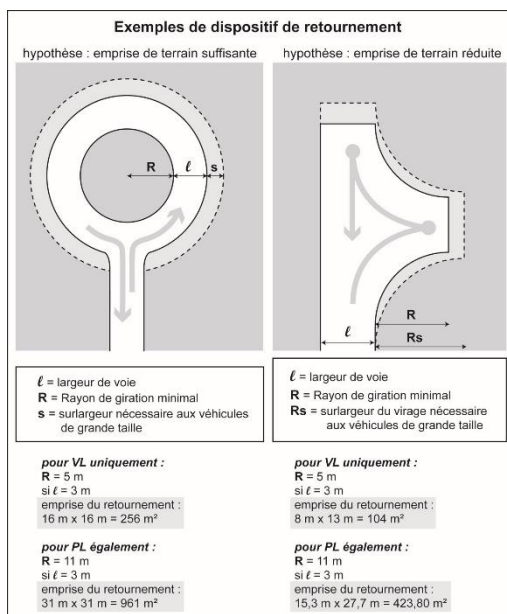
Schéma non opposable de dispositif de retournement d'une voie en impasse
